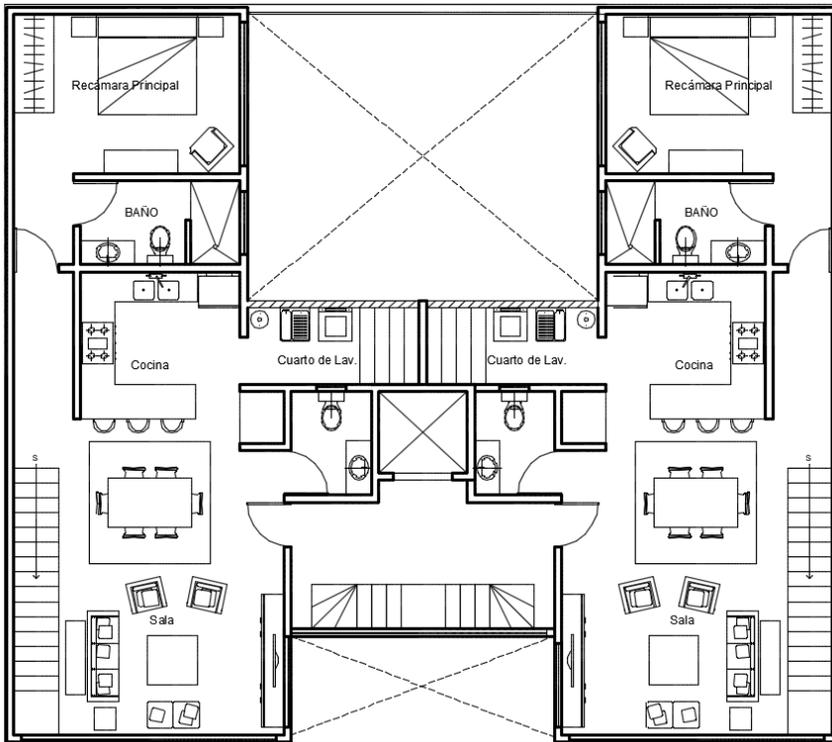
Planta tipo C. Penthouse- planta baja, cuarta hipótesis
